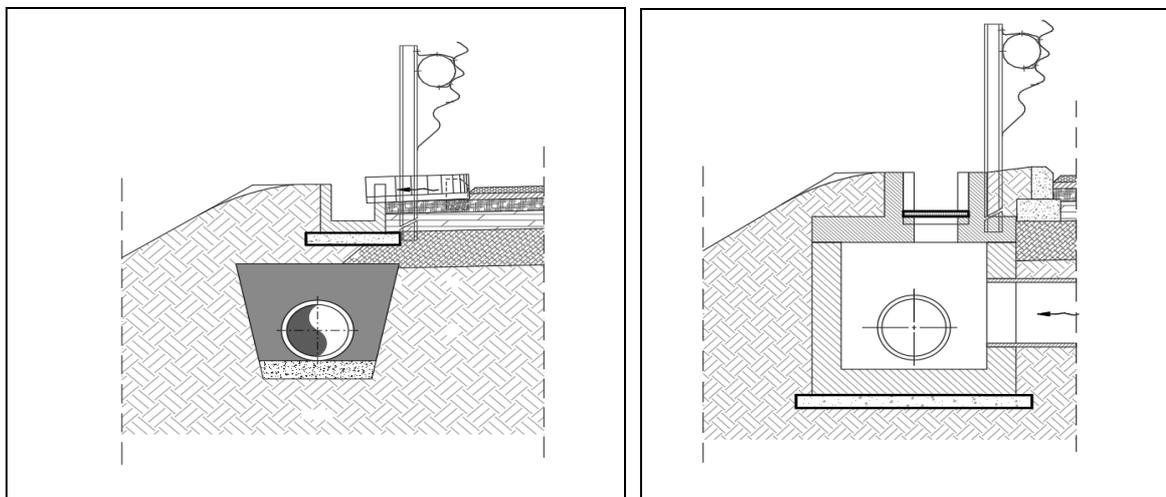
Dettaglio della raccolta ed allontanamento delle acque di piattaforma lato scarpata - sezione corrente e sezione pozzetto
